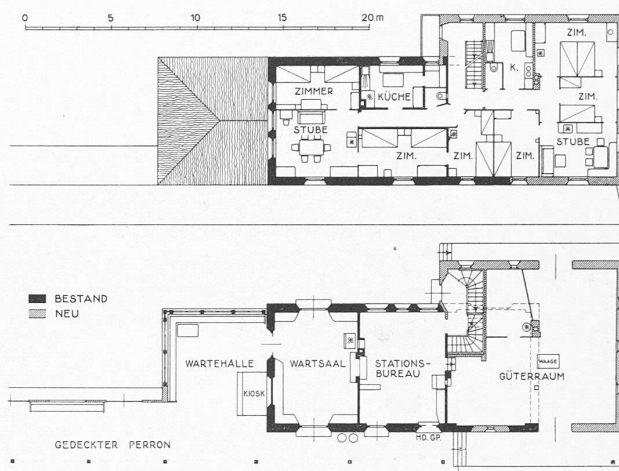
Erweiterte Grundrisse, Parterre und Obergeschoss. — 1:400.
